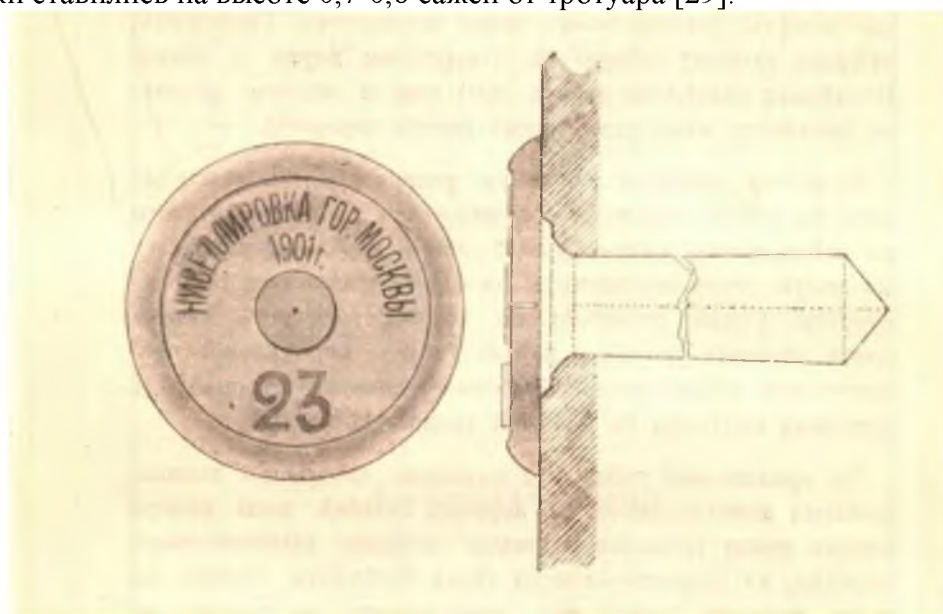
Чертеж марки «Нивелировка гор. Москвы 1901 г.» [29]
